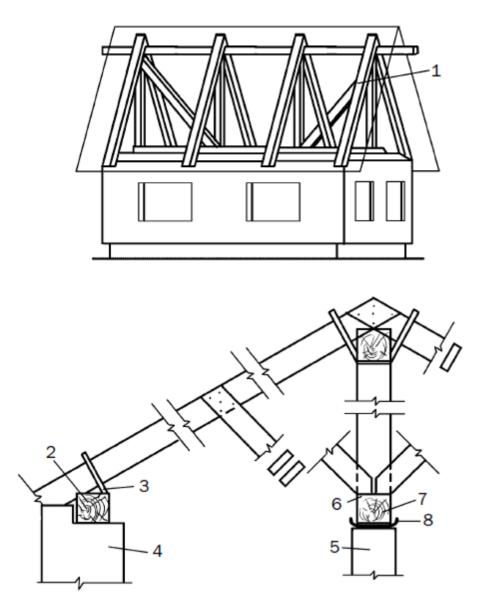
Устройство наклонных стропил: 1 — раскос; 2 — мауэрлат; 3 — скрутка; 4 — наружная стена; 5 — внутренняя стена; 6 — врубка; 7 — лежень; 8 — рубероид
